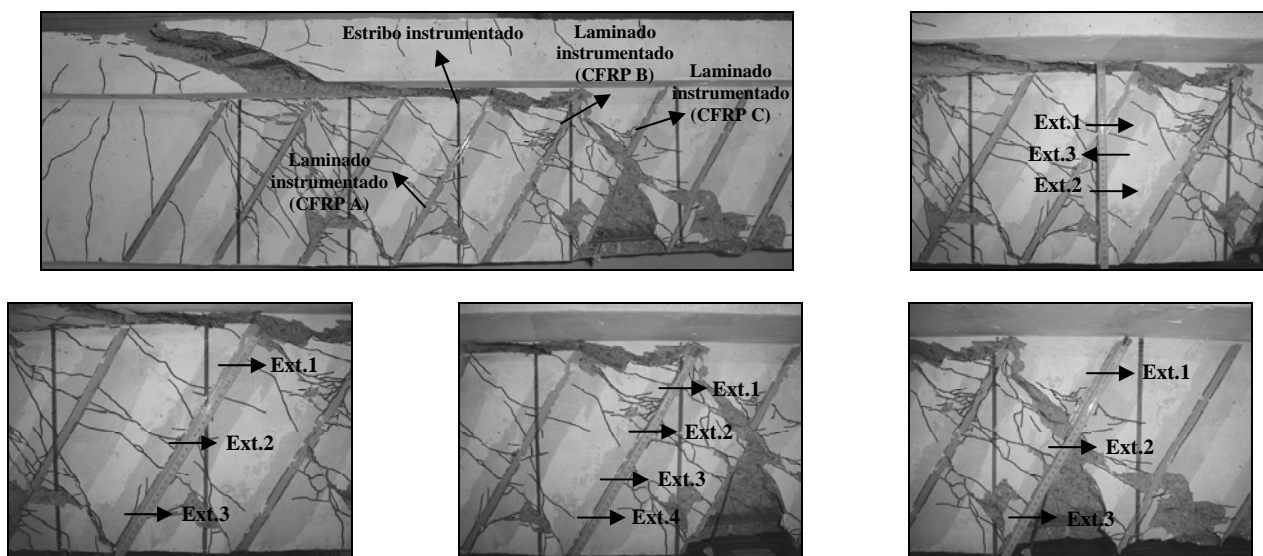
Localização dos extensômetros no laminado e estribo instrumentados da viga 5S-8LI60-D.
